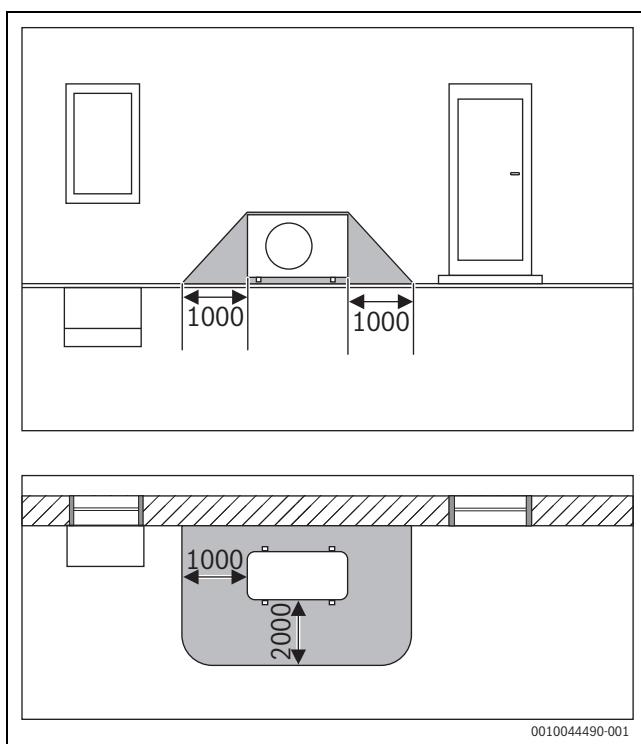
Área de proteção, unidade exterior de chão numa parede (dimensões em mm)
